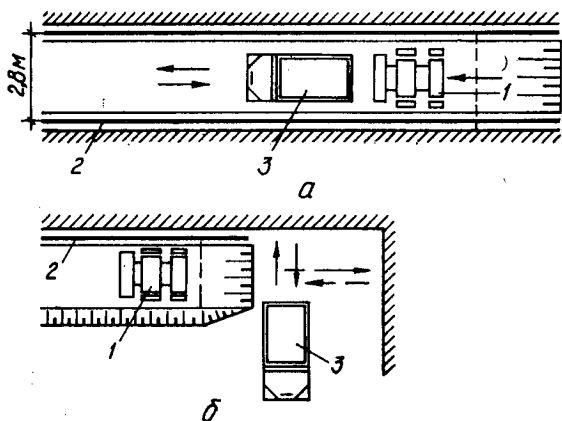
Схемы разработки грунта погрузчиком в стесненных условиях:
